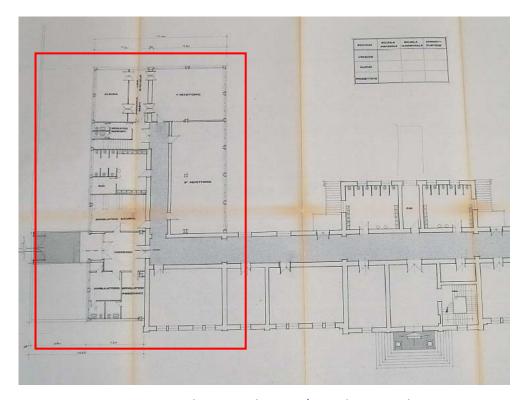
Piano rialzato – ampliamento/sopraelevazione Blocco B
